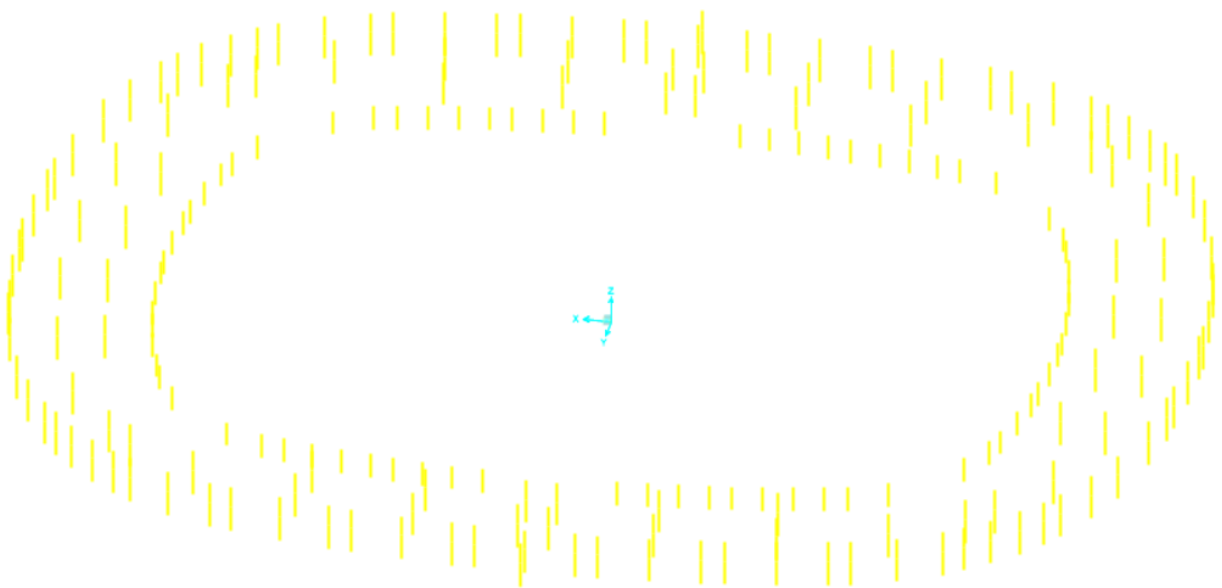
vue global en 3D de disposition des poteaux sur le model
